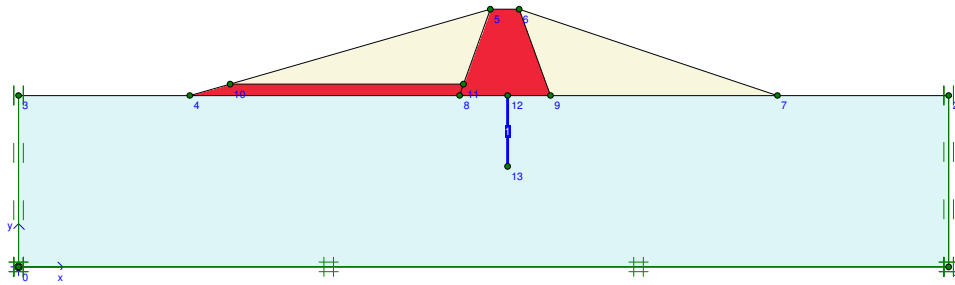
Profil du barrage et ses différentes zones : noyau, recharge, écran et fondation (Plaxis)
